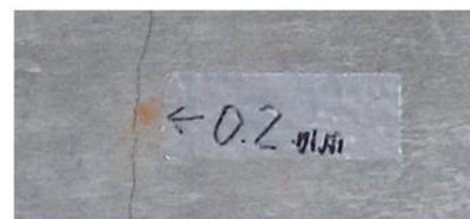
幅0.2mmのひび割れ判別状況
